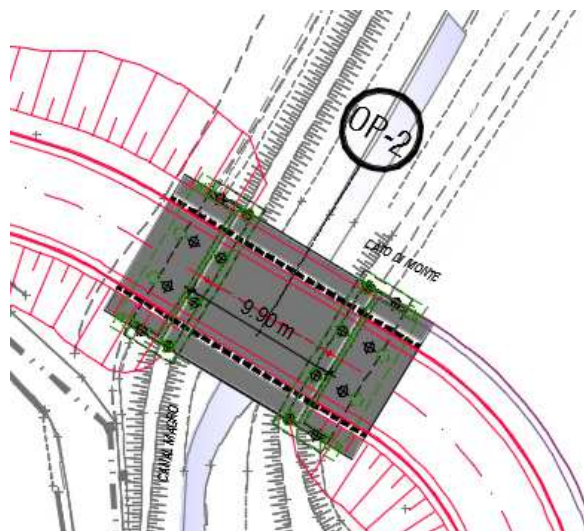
Ponte sul canal magro – estratto planimetria di inquadramento
